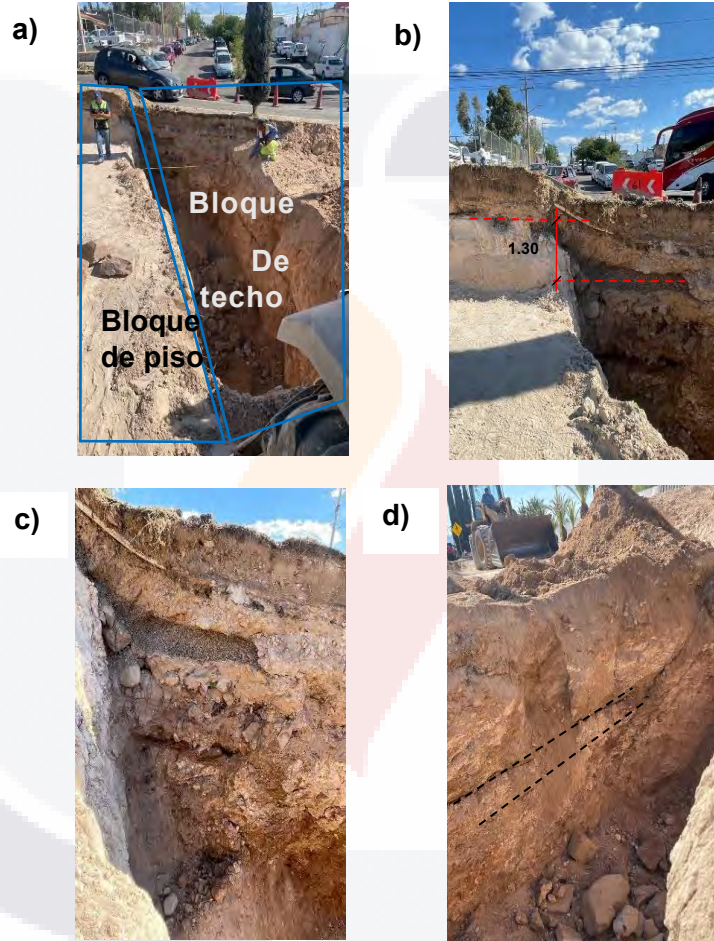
Inspección fotográfica a) Ubicación de bloque de techo y de piso b) Avance del movimiento de la falla oriente c) pared lado sur d) fisuras producidas por la actividad de la falla (Figuras del autor).
